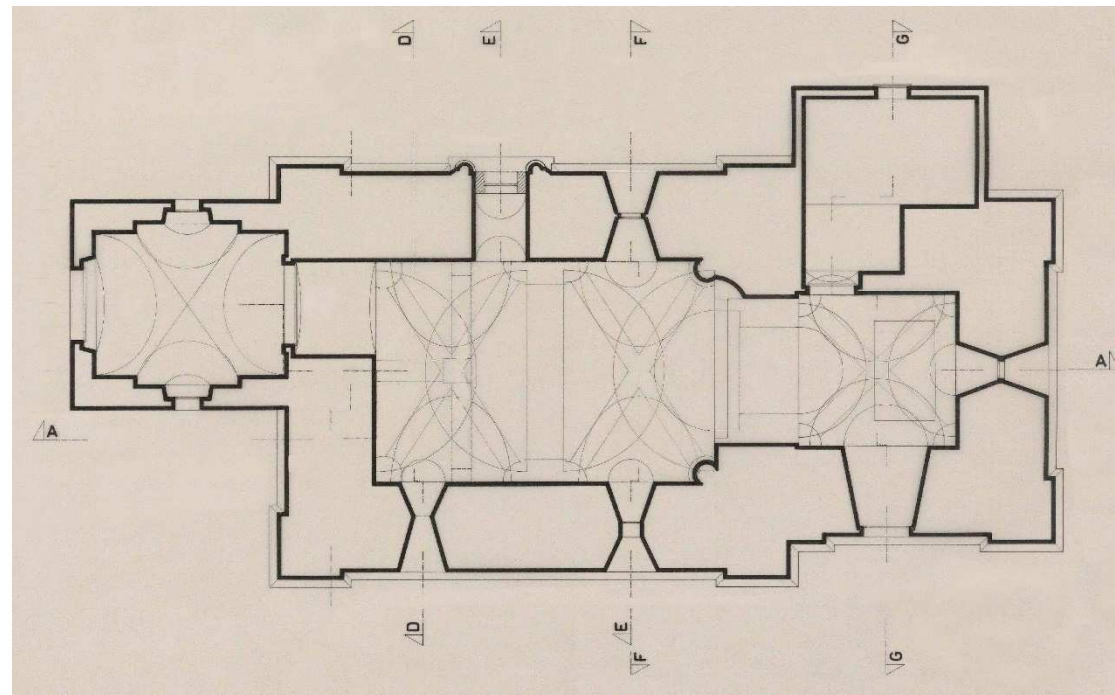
Flk Wildungsmauer, Grundriss
